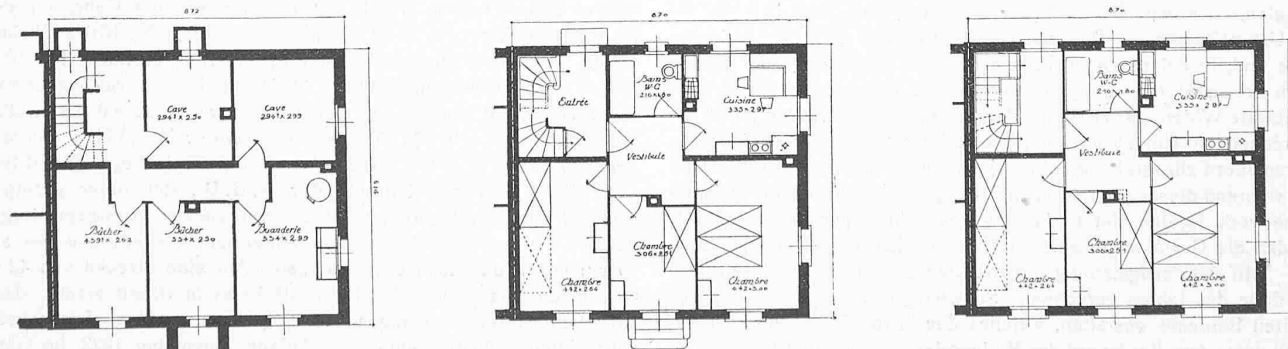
Zweifamilienhaus Typ B. Grundrisse 1:200. — Architekten Gilliard & Godet in Lausanne.
